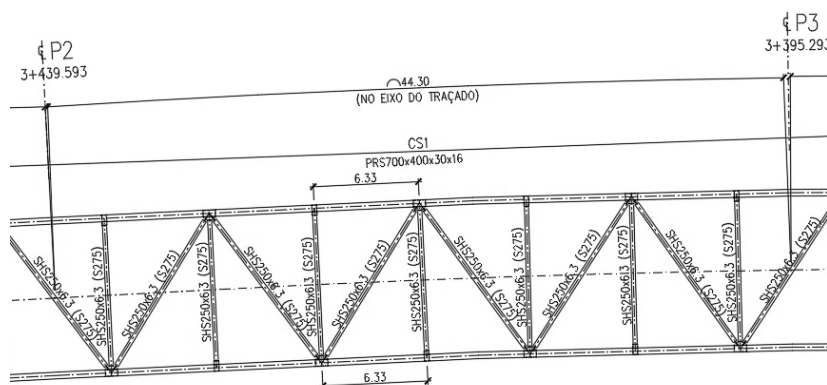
Planta parcial da estrutura metálica aos níveis das cordas superiores.
